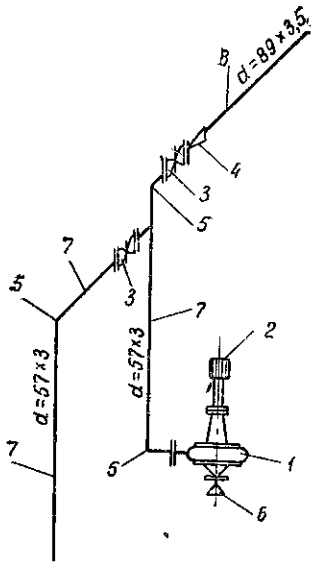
Схема трубопроводов насосной установки с вертикальным насосом
